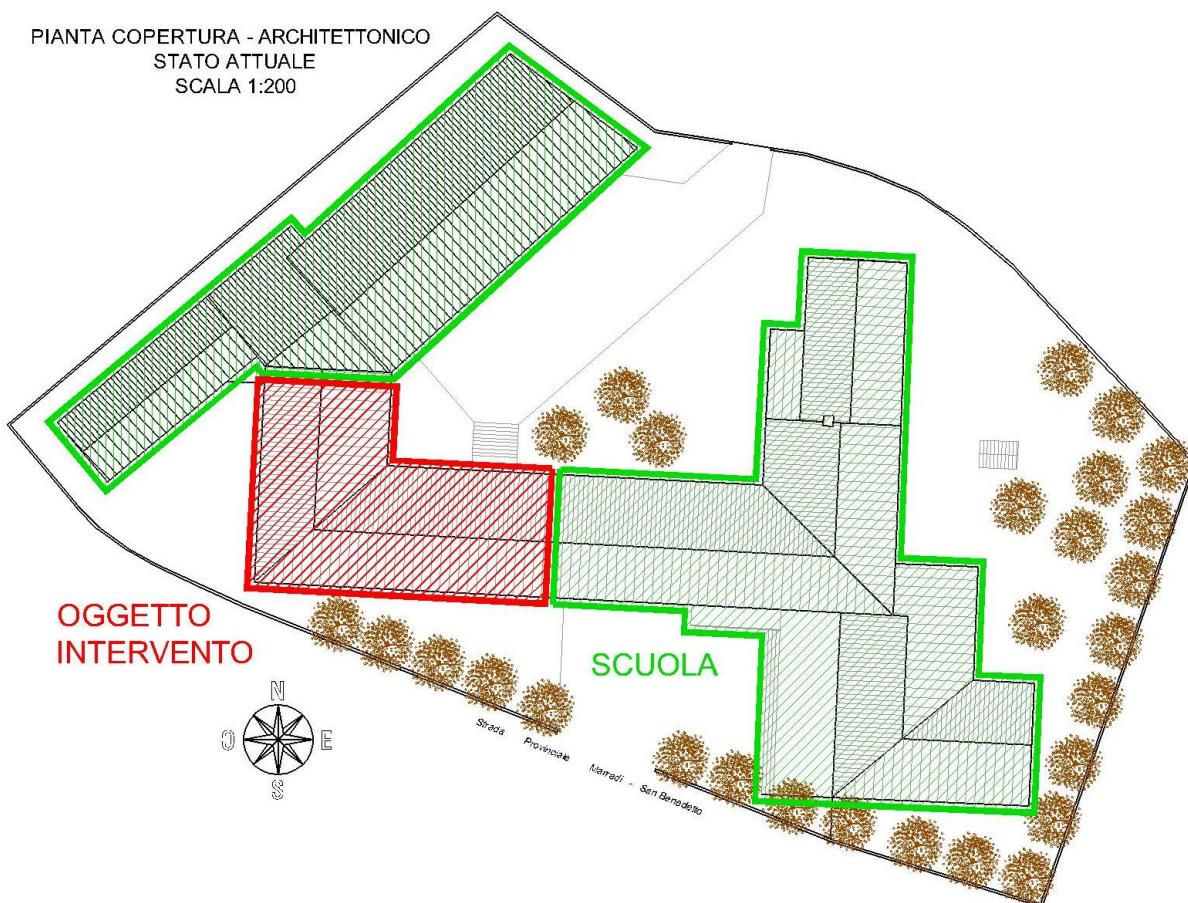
Planimetria del Plesso Scolastico ed individuazione delle unità strutturali
